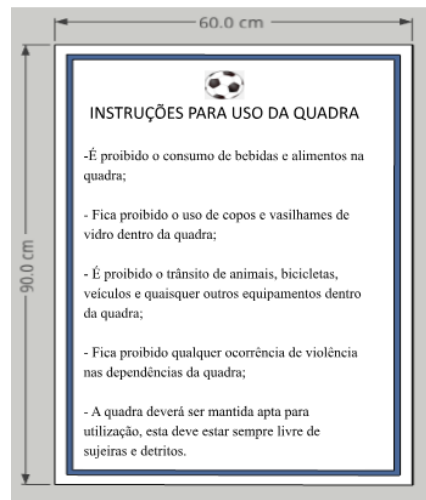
Detalhe Ilustrativo de placa de instruções (Fonte: Autor/2024)
